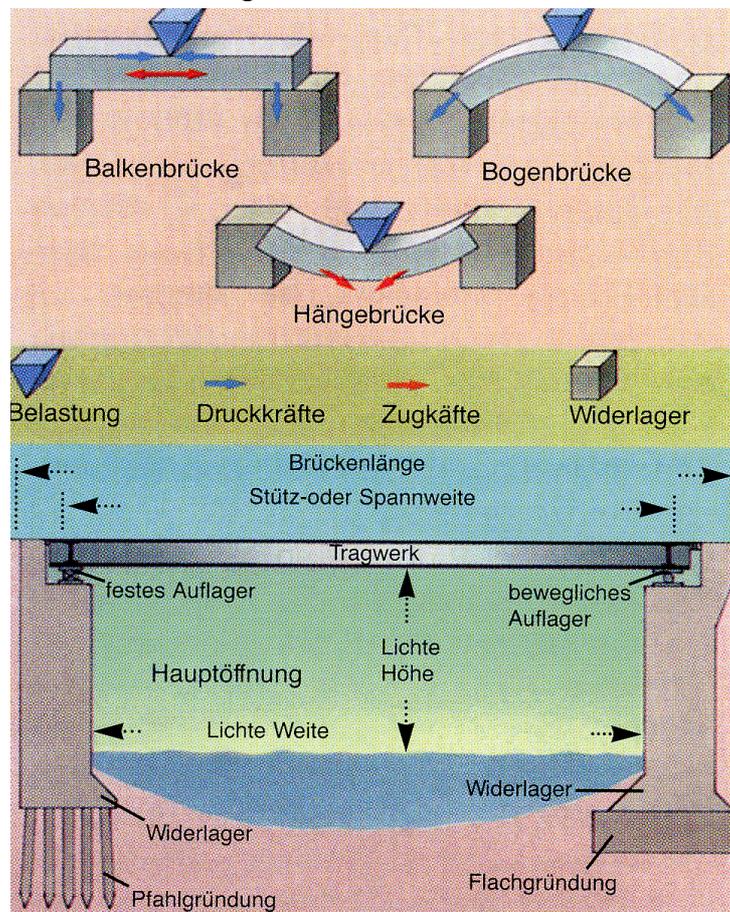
Oben - die grundlegenden Bauformen mit den jeweiligen Kräfteverteilungen. Unten - wichtige Fachbegriffe des Brückenkonstruktors
